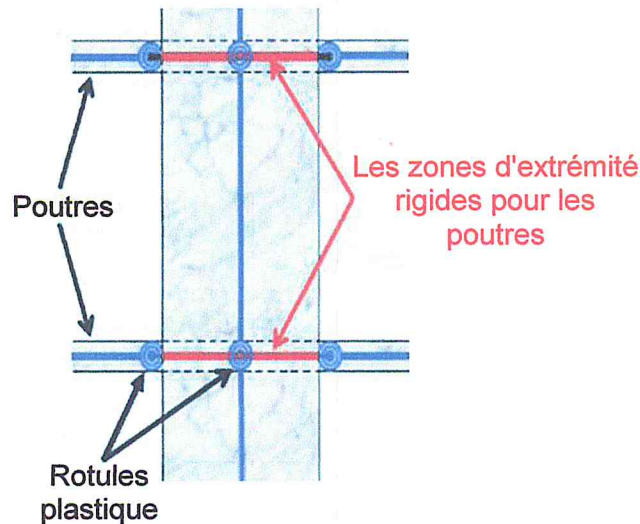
Modèle « Poteau-Poutre équivalent ».
